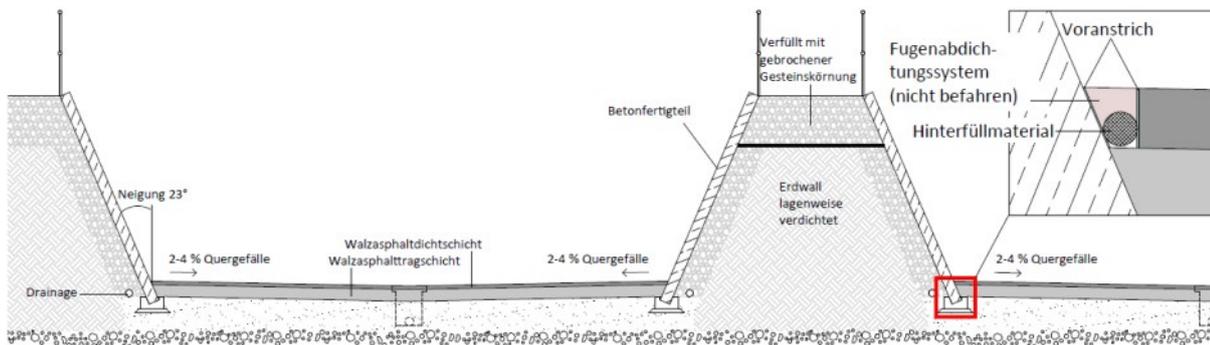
Asphalt - Betonfertigteil (Traunsteiner Wand); weitere Details siehe abZ/aBG, Anlage 1 - 6
